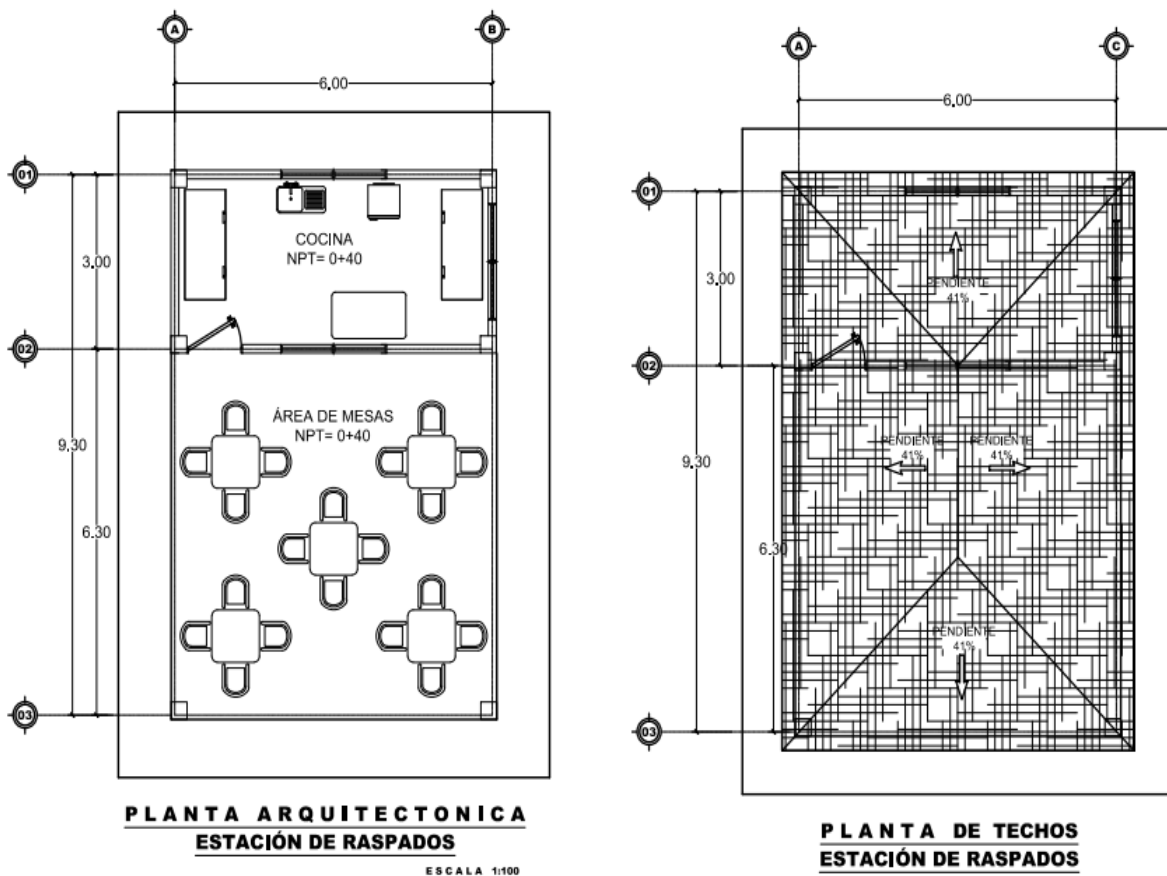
Planta arquitectonica y techo Estacion de raspados
